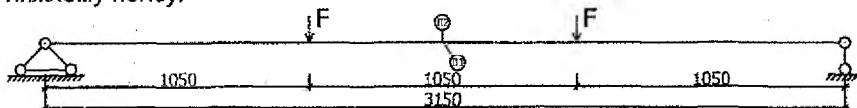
Расчётная схема двутавровой сварной балки, нагруженной по верхнему поясу.
